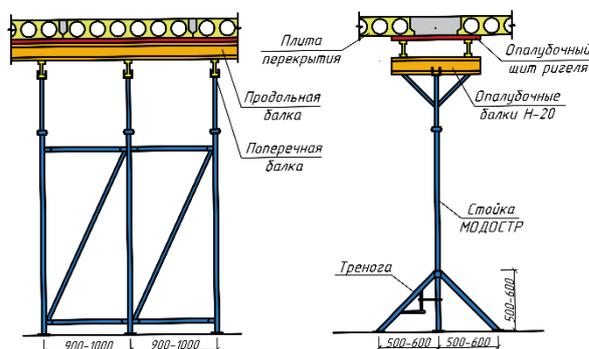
Элементы опалубочной системы МОДОСТР для устройства сборно-монолитных перекрытий
